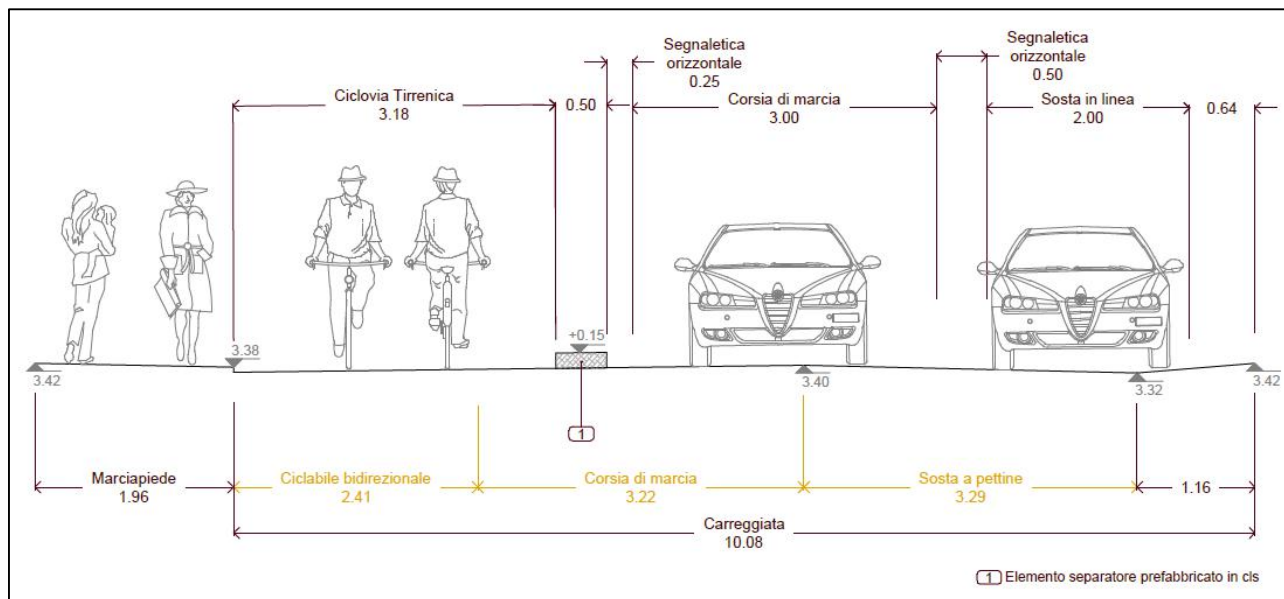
Sezione 03 di progetto trasversale su Viale Italia
